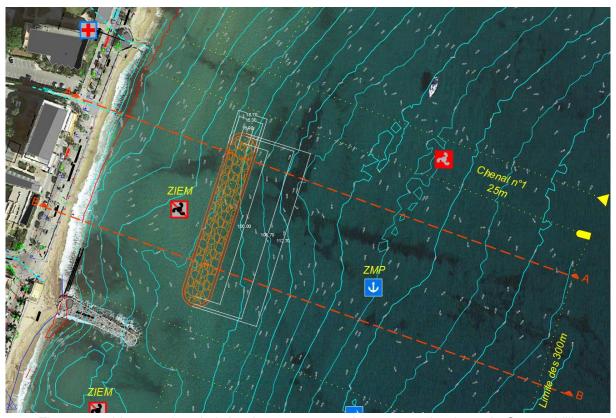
Vue en plan du brise-lames en enrochement sur la plage du Centre-Ville
